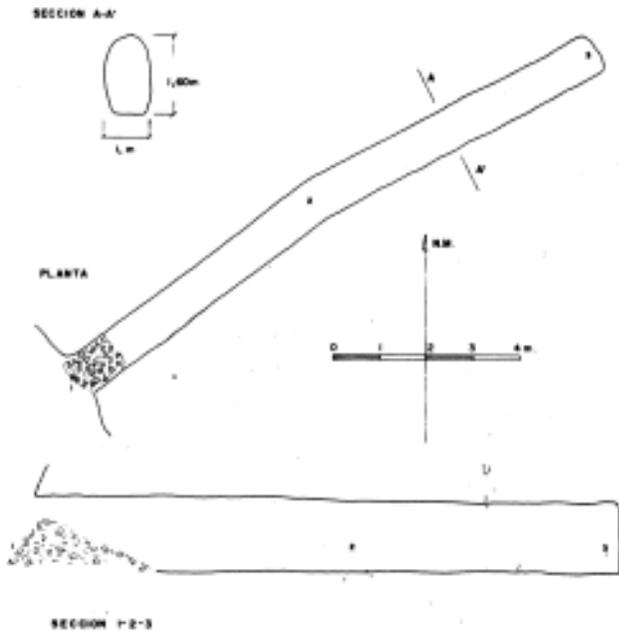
Plano de la galería romana 6 (planta y secciones).
